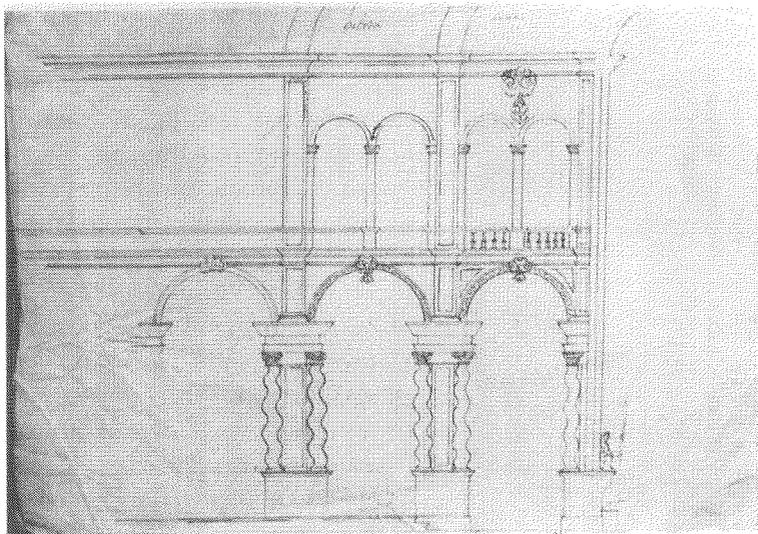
Domingo A. de Andrade. Alzado de la capilla mayor.
